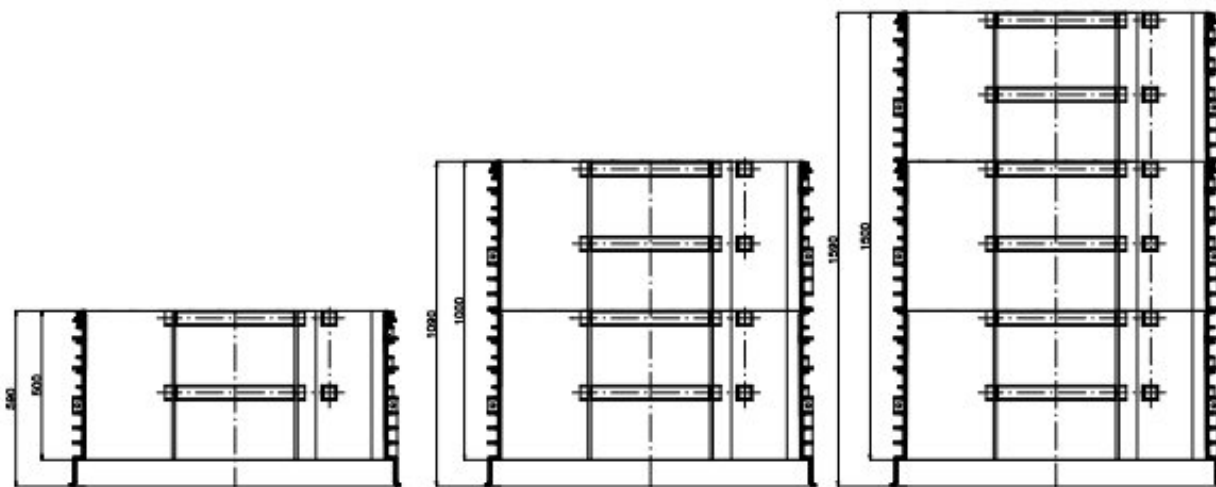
Кольца корпуса колодцев PRO 800, 1000
